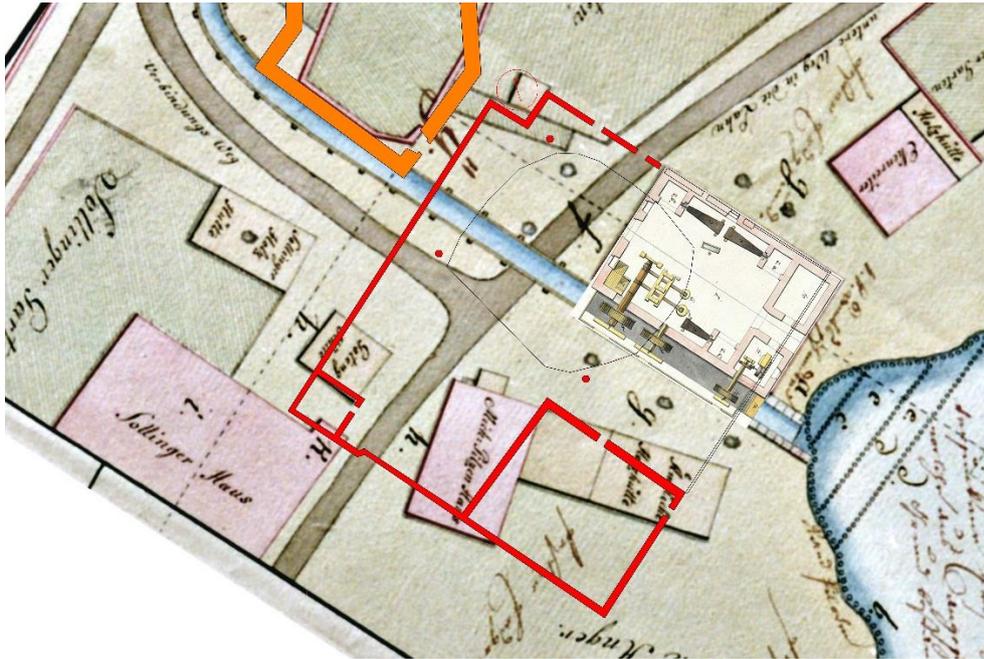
Grundriss des Pfannhauses und der Amtsschmiede über den Lageplan Rutschung von 1808, Montage F. Idam.
